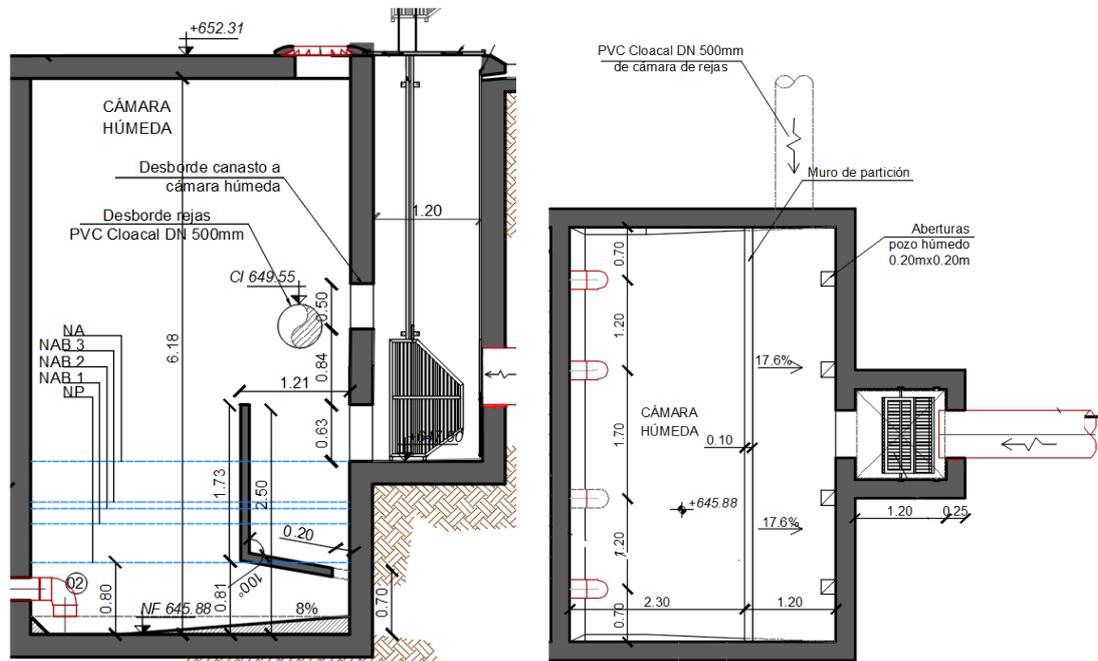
Cámara Húmeda EE: corte (izq.), planta (der.)
